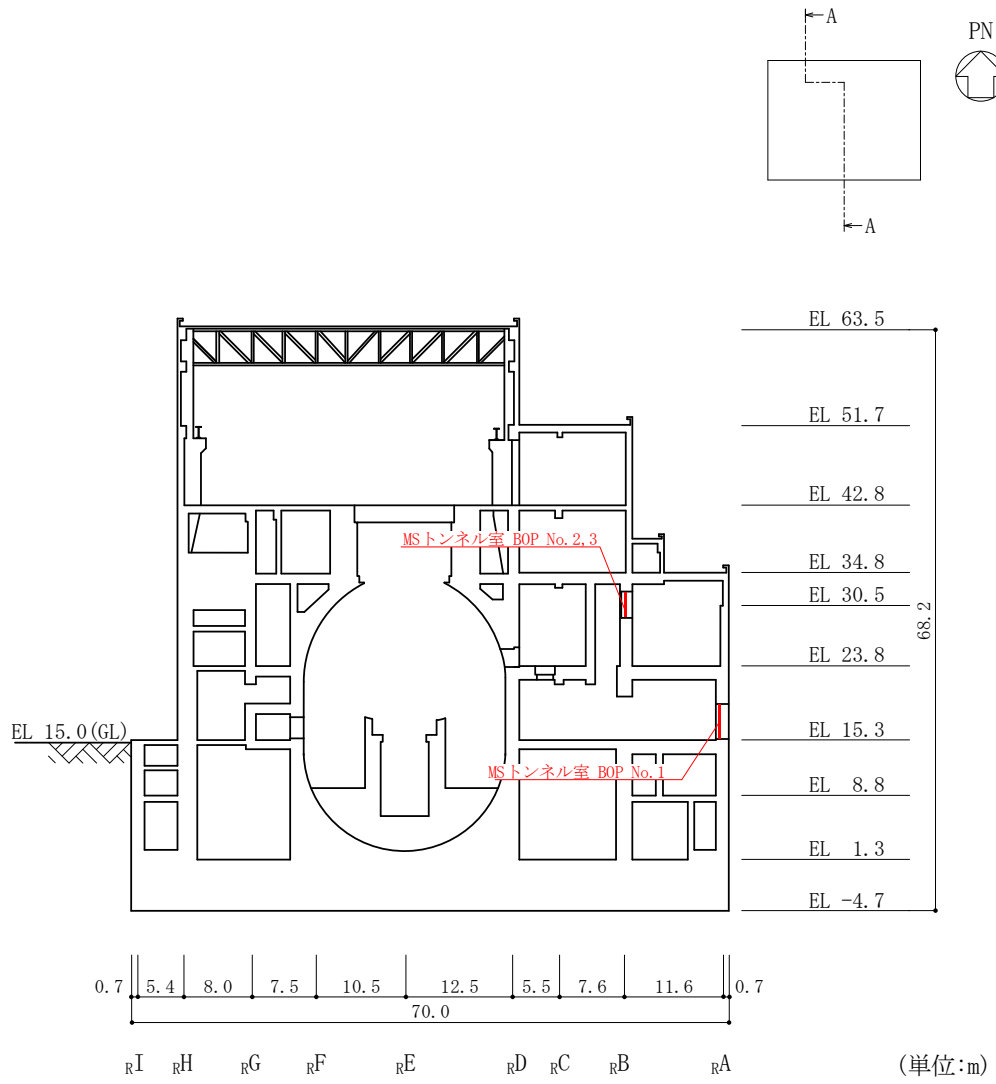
MS トンネル室 BOP の設置位置断面図 (A-A 断面)
